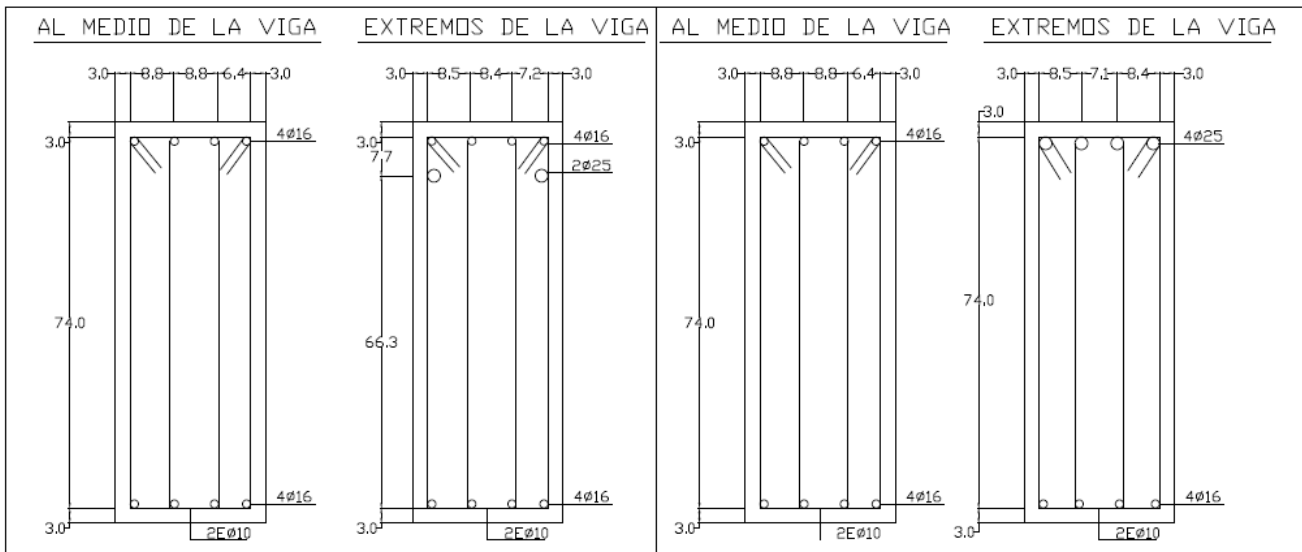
Sección transversal de las vigas del piso 2 de la estructura aislada
